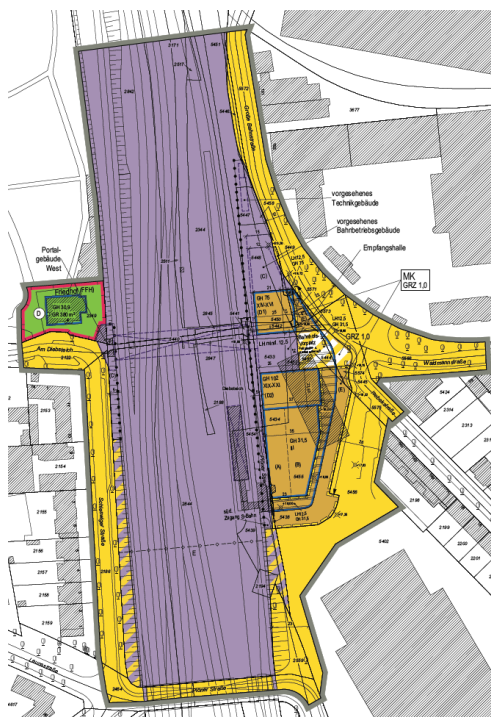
Planzeichnung Bebauungsplan-Entwurf Altona Nord 27/ Bahrenfeld 72_ [U10]
